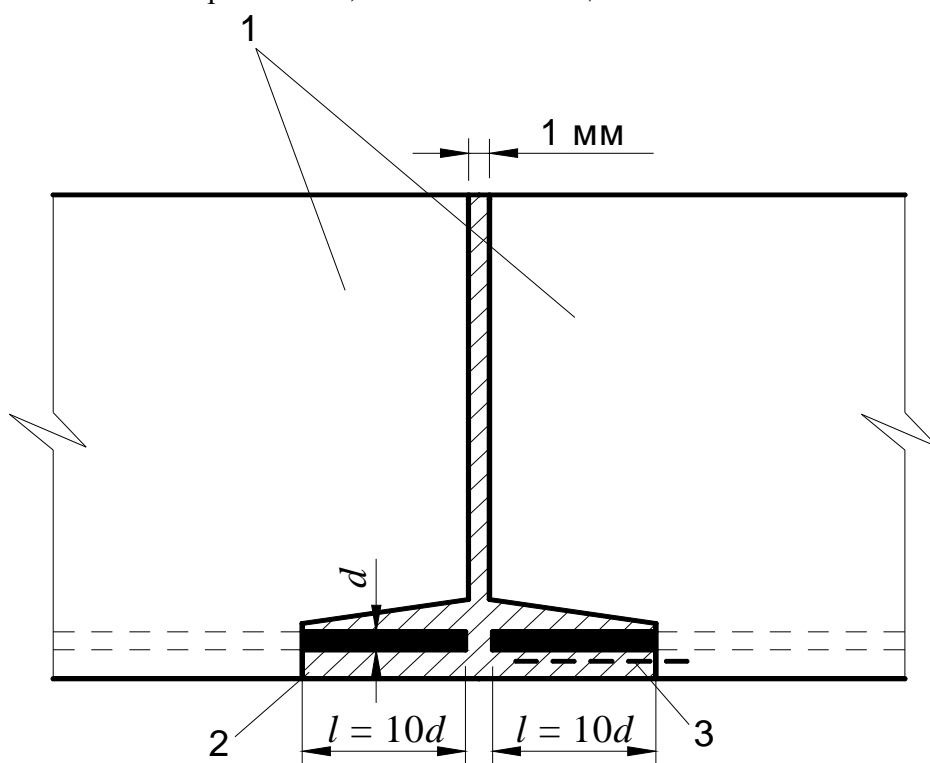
Соединение железобетонных элементов на эпоксидном составе без сварки
